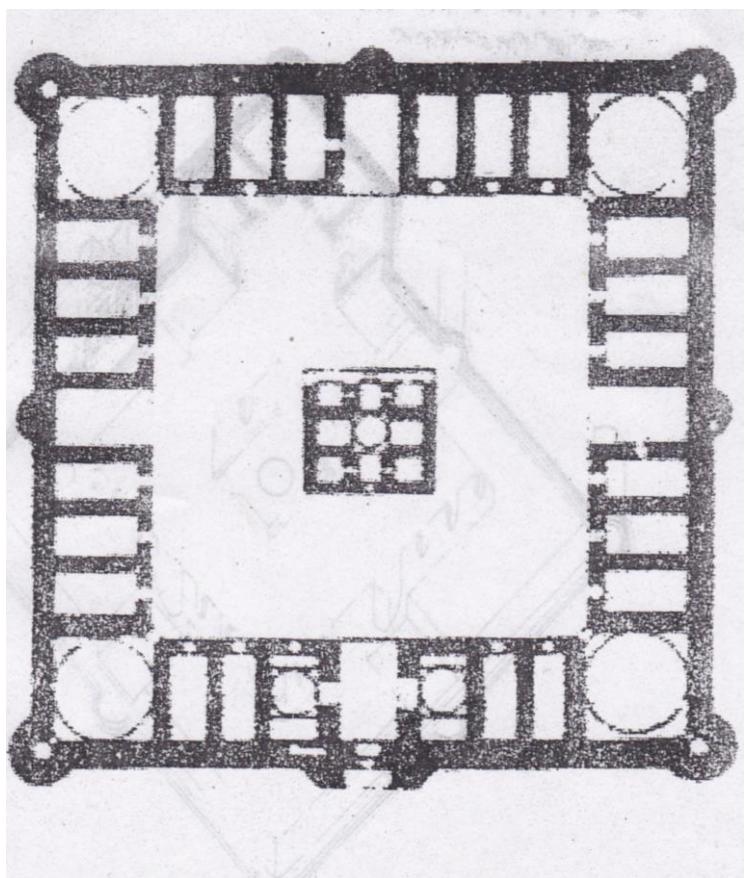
مسقط افقي لخان خمسة أباد طريق ساوية من العصر
